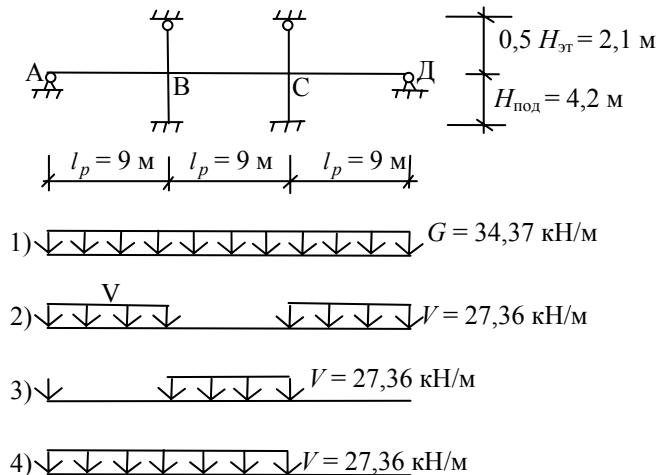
Расчётная схема рамы и сочетания нагрузок
